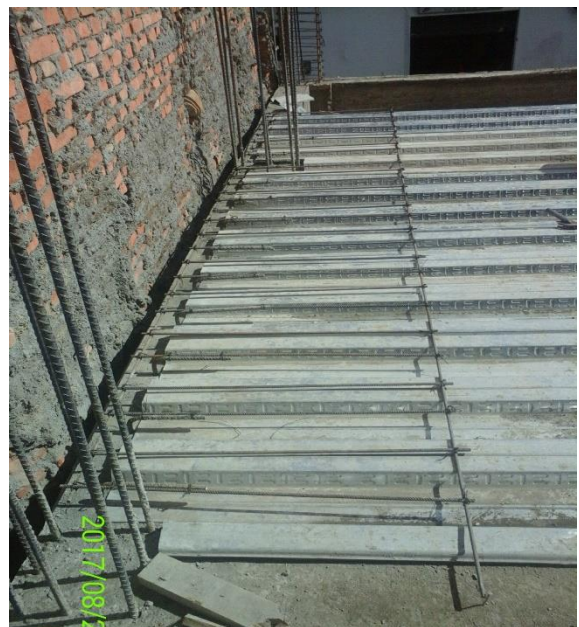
DESENCOFRADO DE VIGAS DE ENTREPISO EN EL NIVEL 2.
